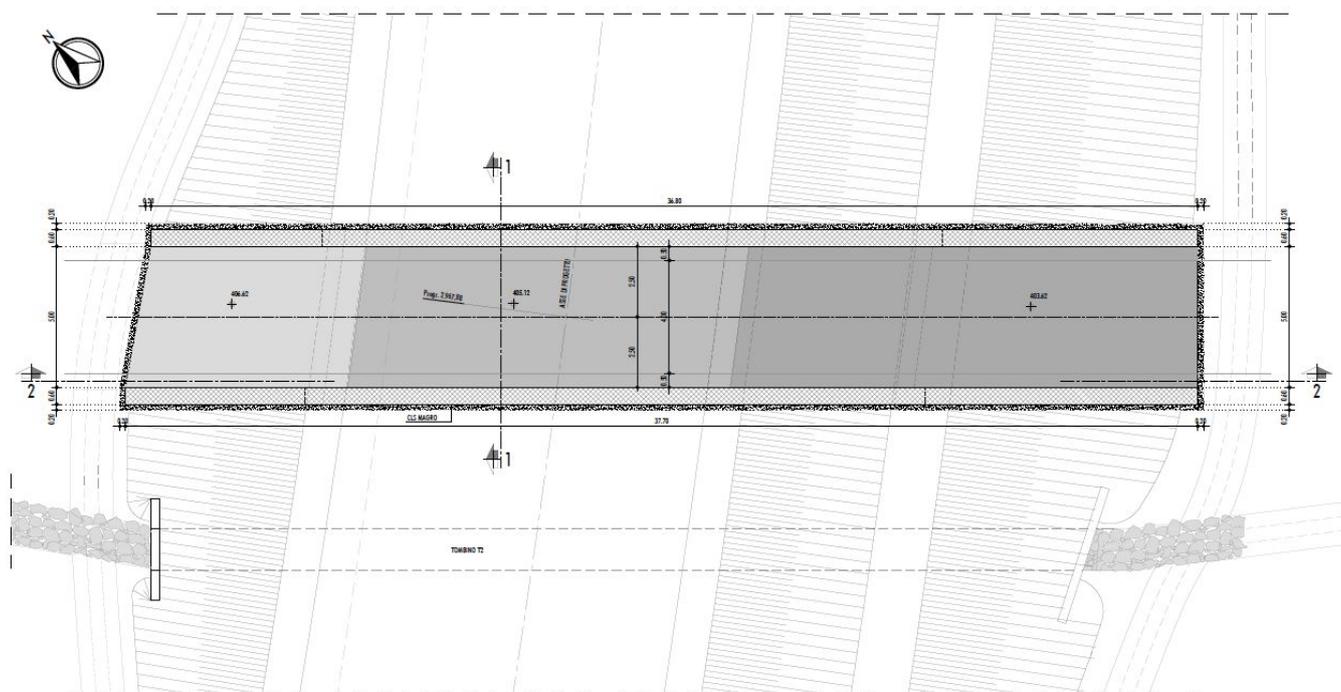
PLANIMETRIA SOTTOPASSO PK 2+968.93
